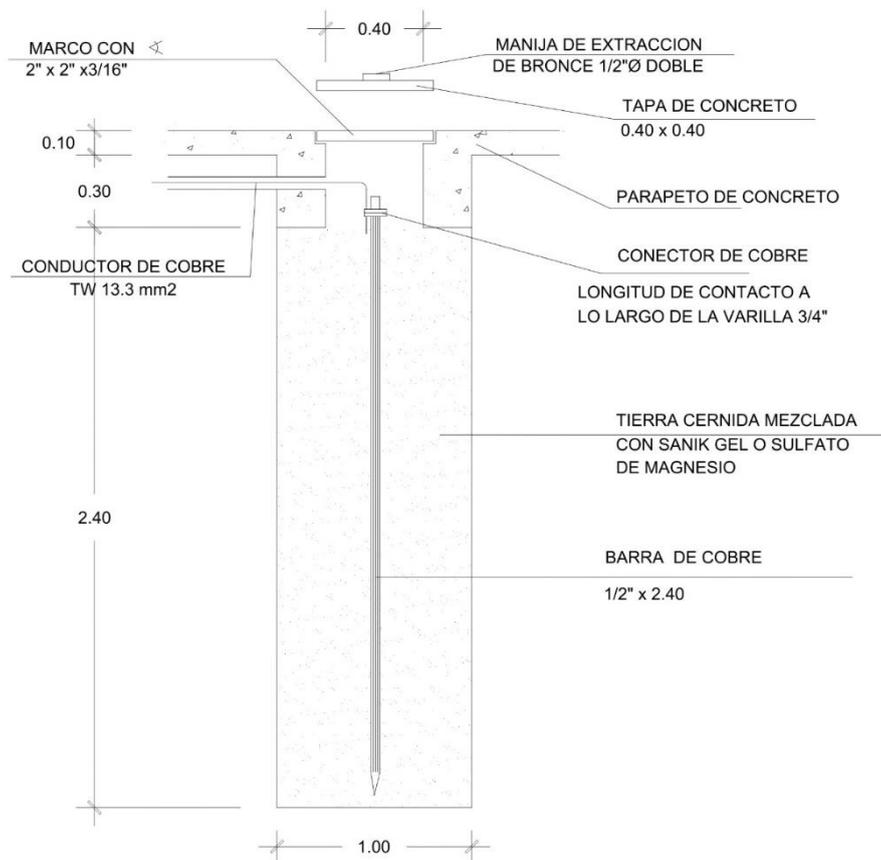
Detalle de puesta a tierra. Fuente: elaboración propia
